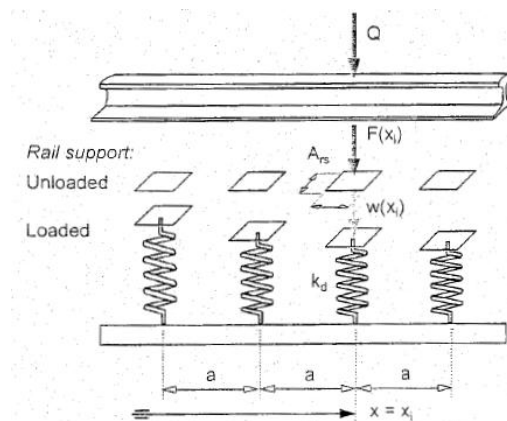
Modelo de Winkler aplicado ao apoio discreto [1]
